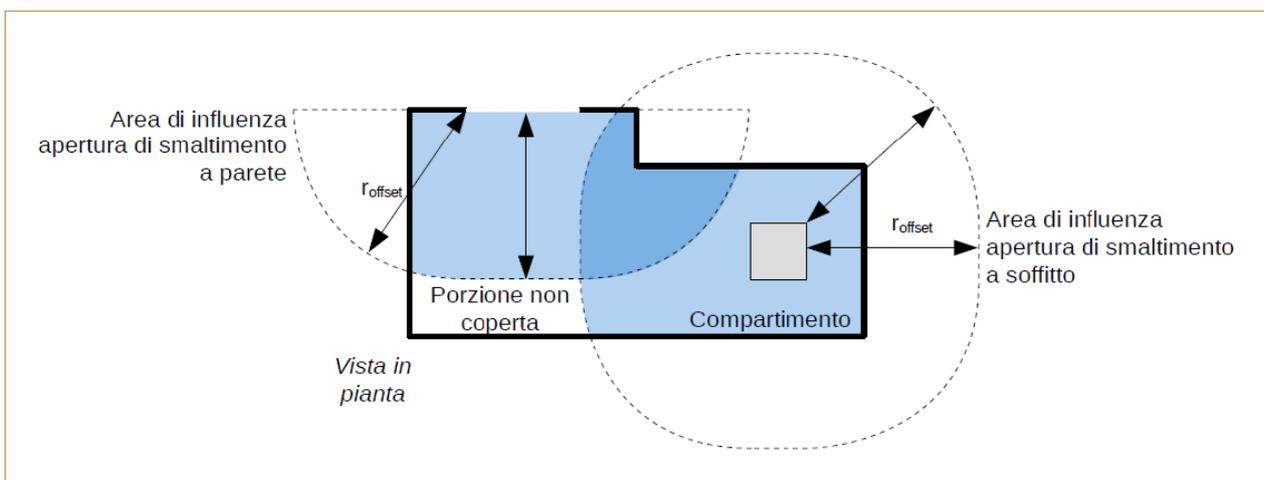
Verifica dell'uniforme distribuzione in pianta delle aperture di smaltimento
